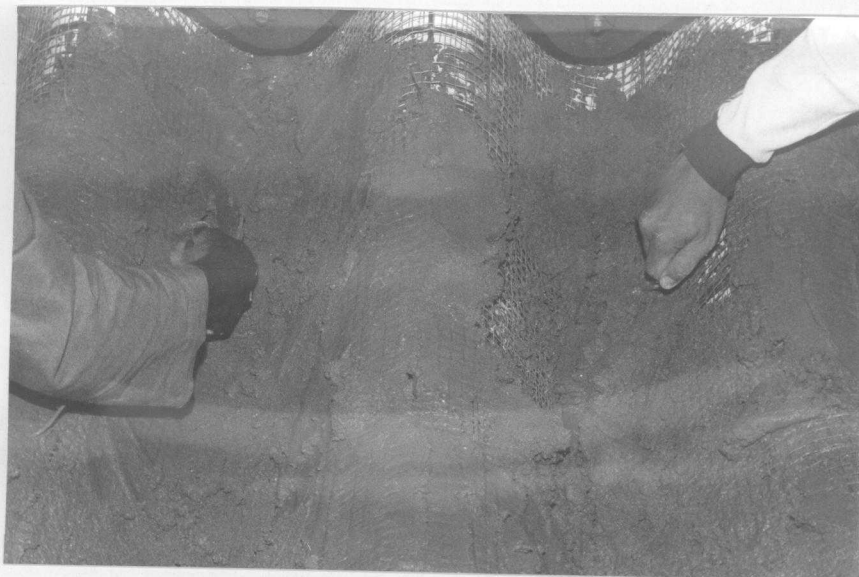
Concretagem do modelo 2 - colocação da argamassa.
